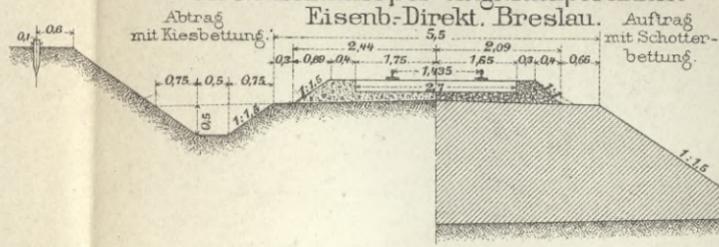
Bahnkörper engl. Nebenbahnen, Eisenb.-Direkt. Breslau.
